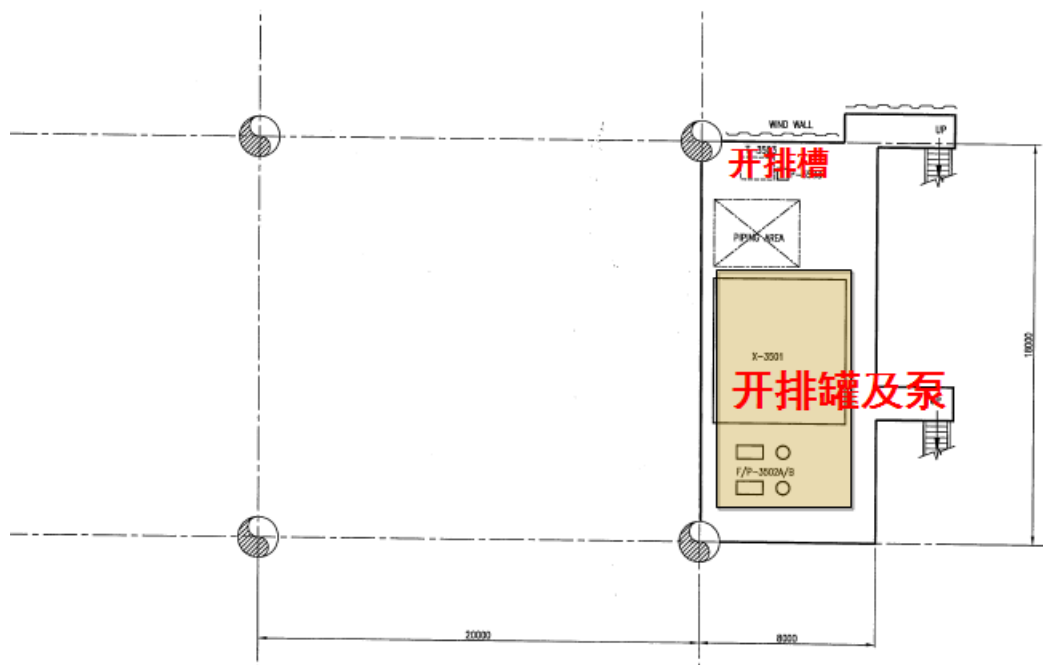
QHD32-6CEPL 平台工作甲板平面布置图
